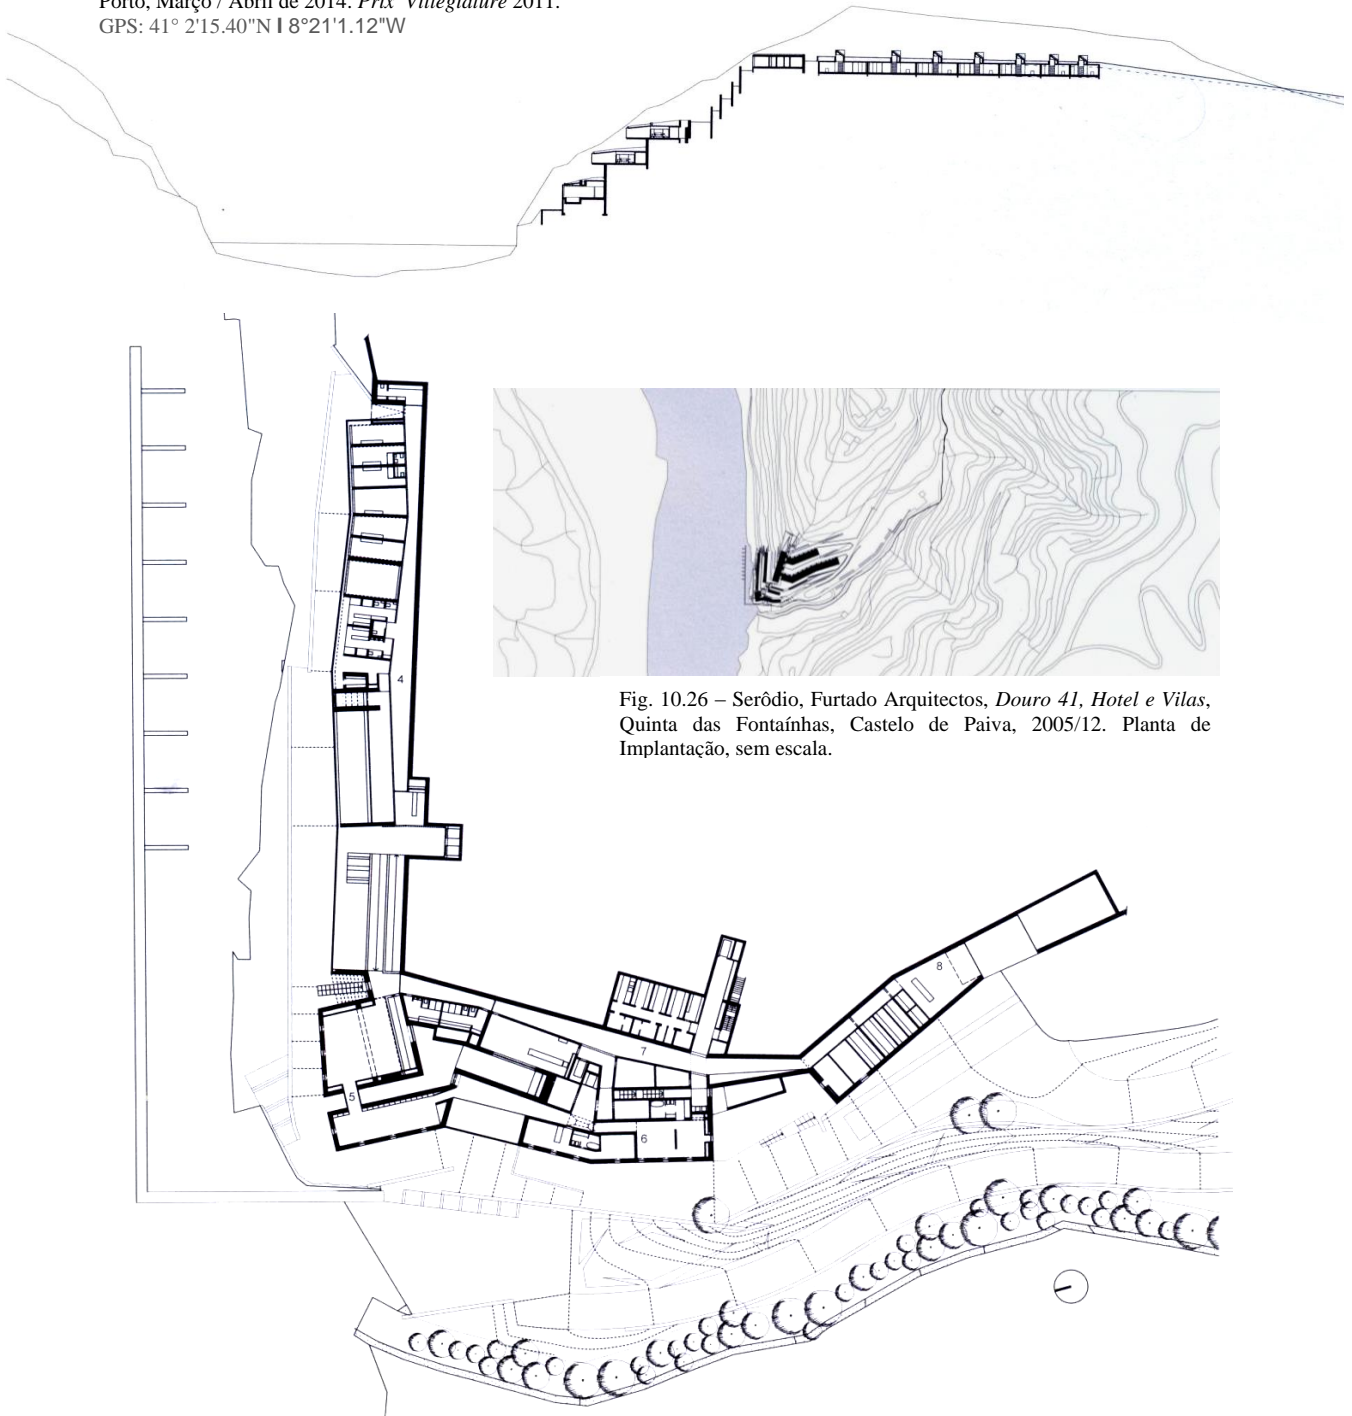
Serôdio, Furtado Arquitectos, *Douro 41, Hotel e Vilas*, Quinta das Fontainhas, Castelo de Paiva, 2005/12. Planta de Implantação, sem escala.
